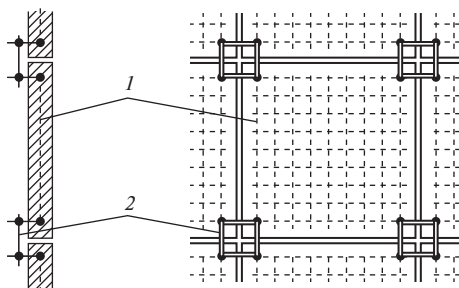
Монтаж соединительных проводов на плитах из предварительно напряженного железобетона с помощью сварки или болтовых соединений:
